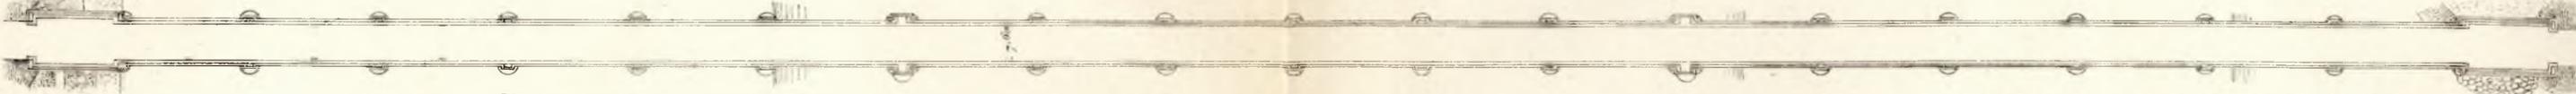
Prospetto a monte verso la spalla sinistra.
